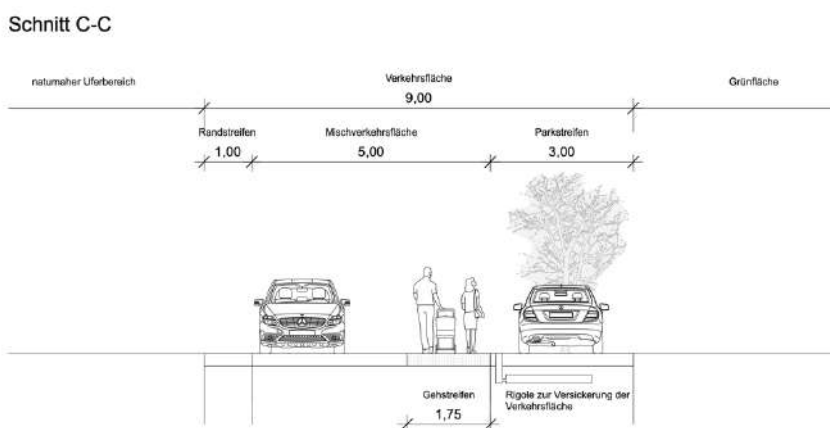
möglicher Straßenquerschnitt C-C – Verkehrsfläche inklusive Parkstreifen
